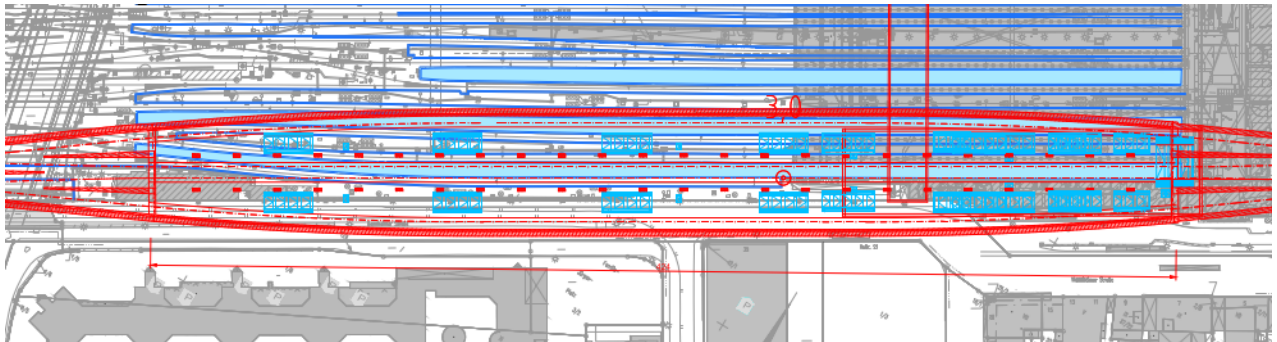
Ausschnitt aus dem Lageplan [2]
